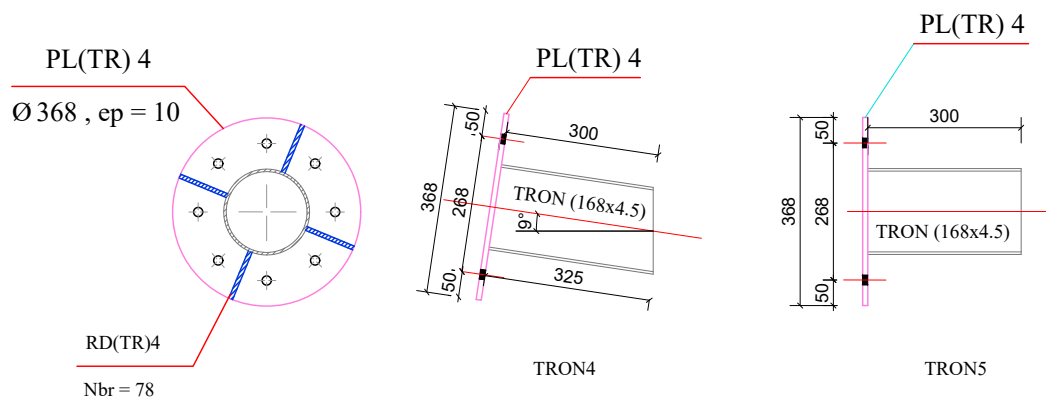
Détail de l'assemblage tubulaire du nœud ferme-poteau
